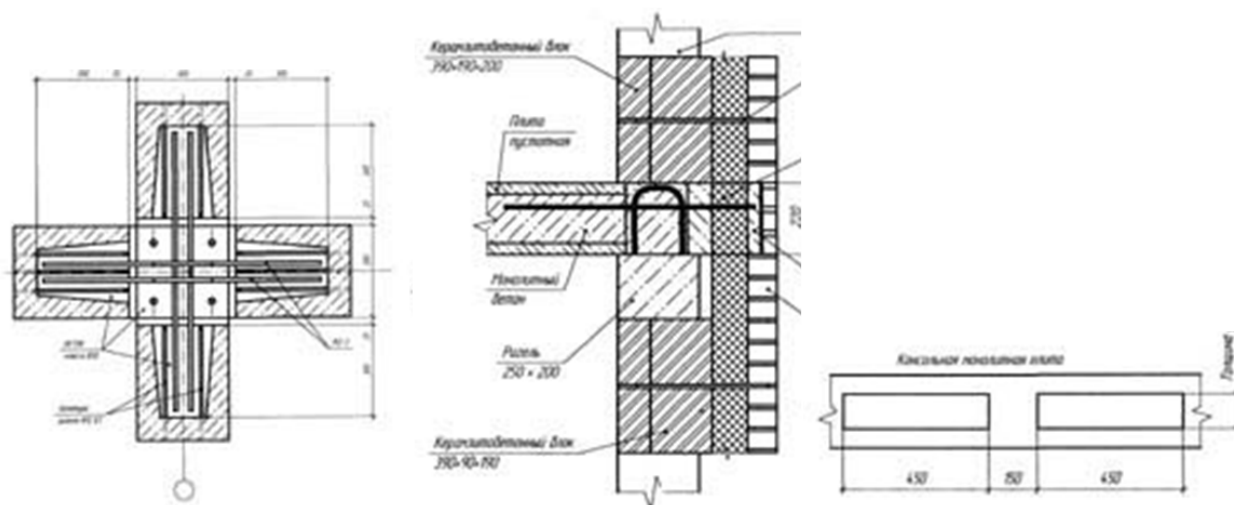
Соединение колонна-ригель-плита перекрытия [5]: несъемная плита-опалубка
